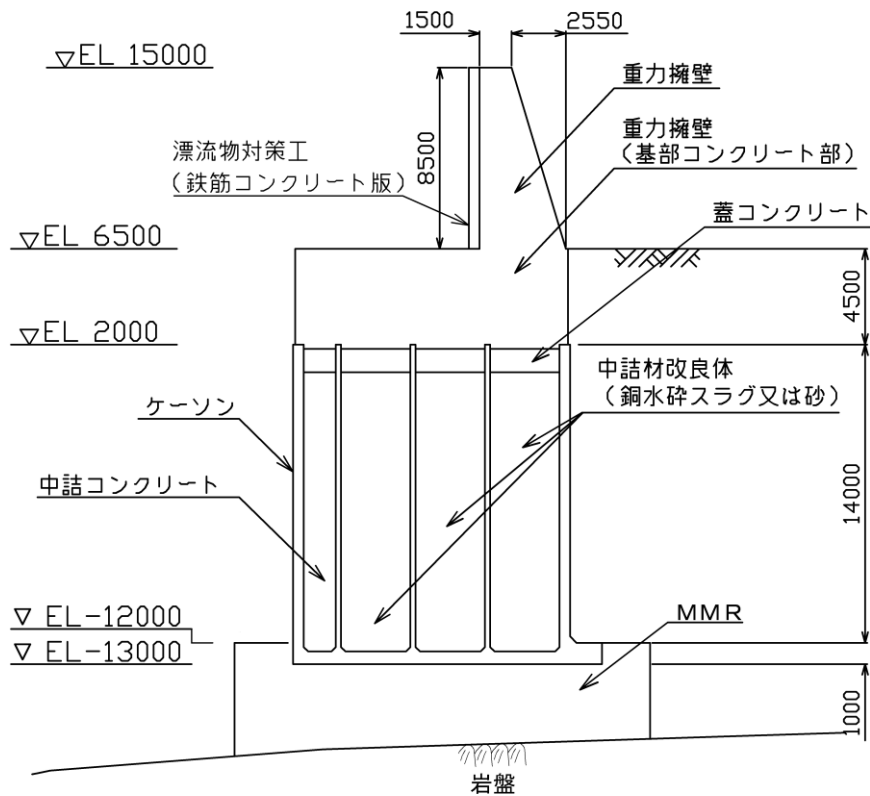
(2) 防波壁（波返重力擁壁）の構造図（断面図）（ケーソン設置部）
